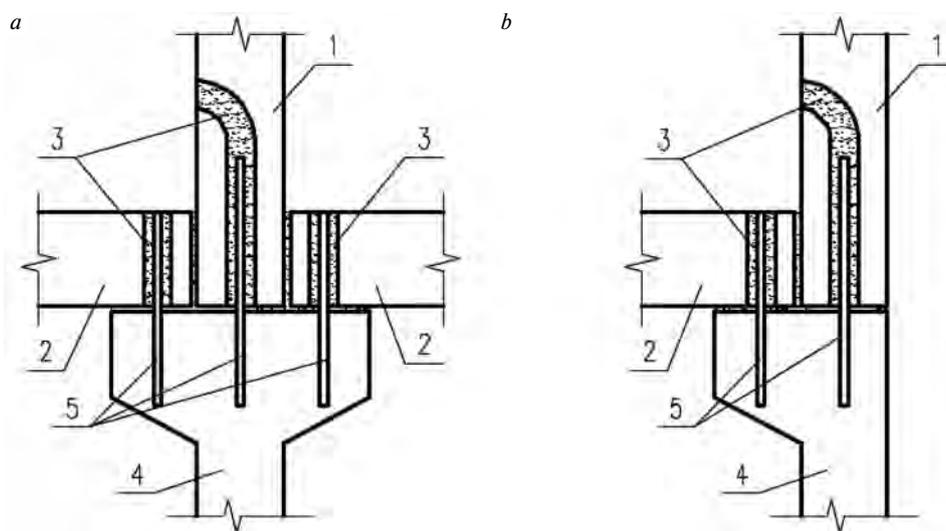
Принципиальные комбинированные соединения сборных элементов плит и стен с применением стыков штепсельного типа в крупнопанельных конструктивных системах: а – контактный стык с односторонним опиранием плит; б – то же с двухсторонним опиранием плит; 1 – сборная стенная панель; 2 – сборная плита перекрытия; 3 – канал в бетоне; 4 – сборная стенная панель с консолью; 5 – арматурный или стальной выпуск
